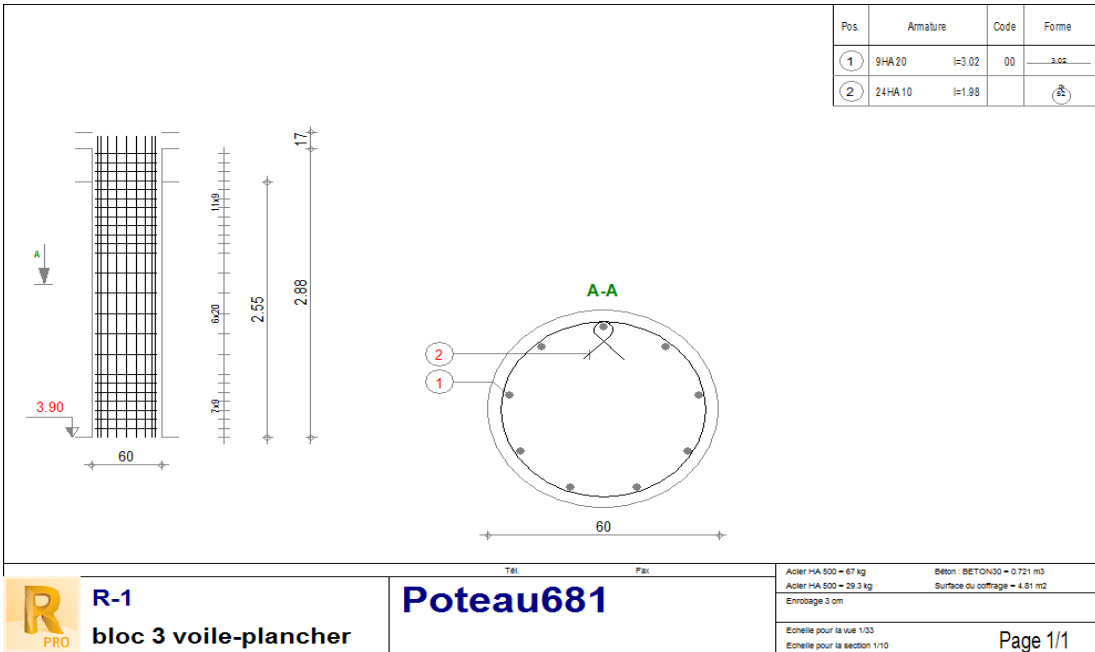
Ferrailage des poteaux P49, P50 et P51 (R-1)
